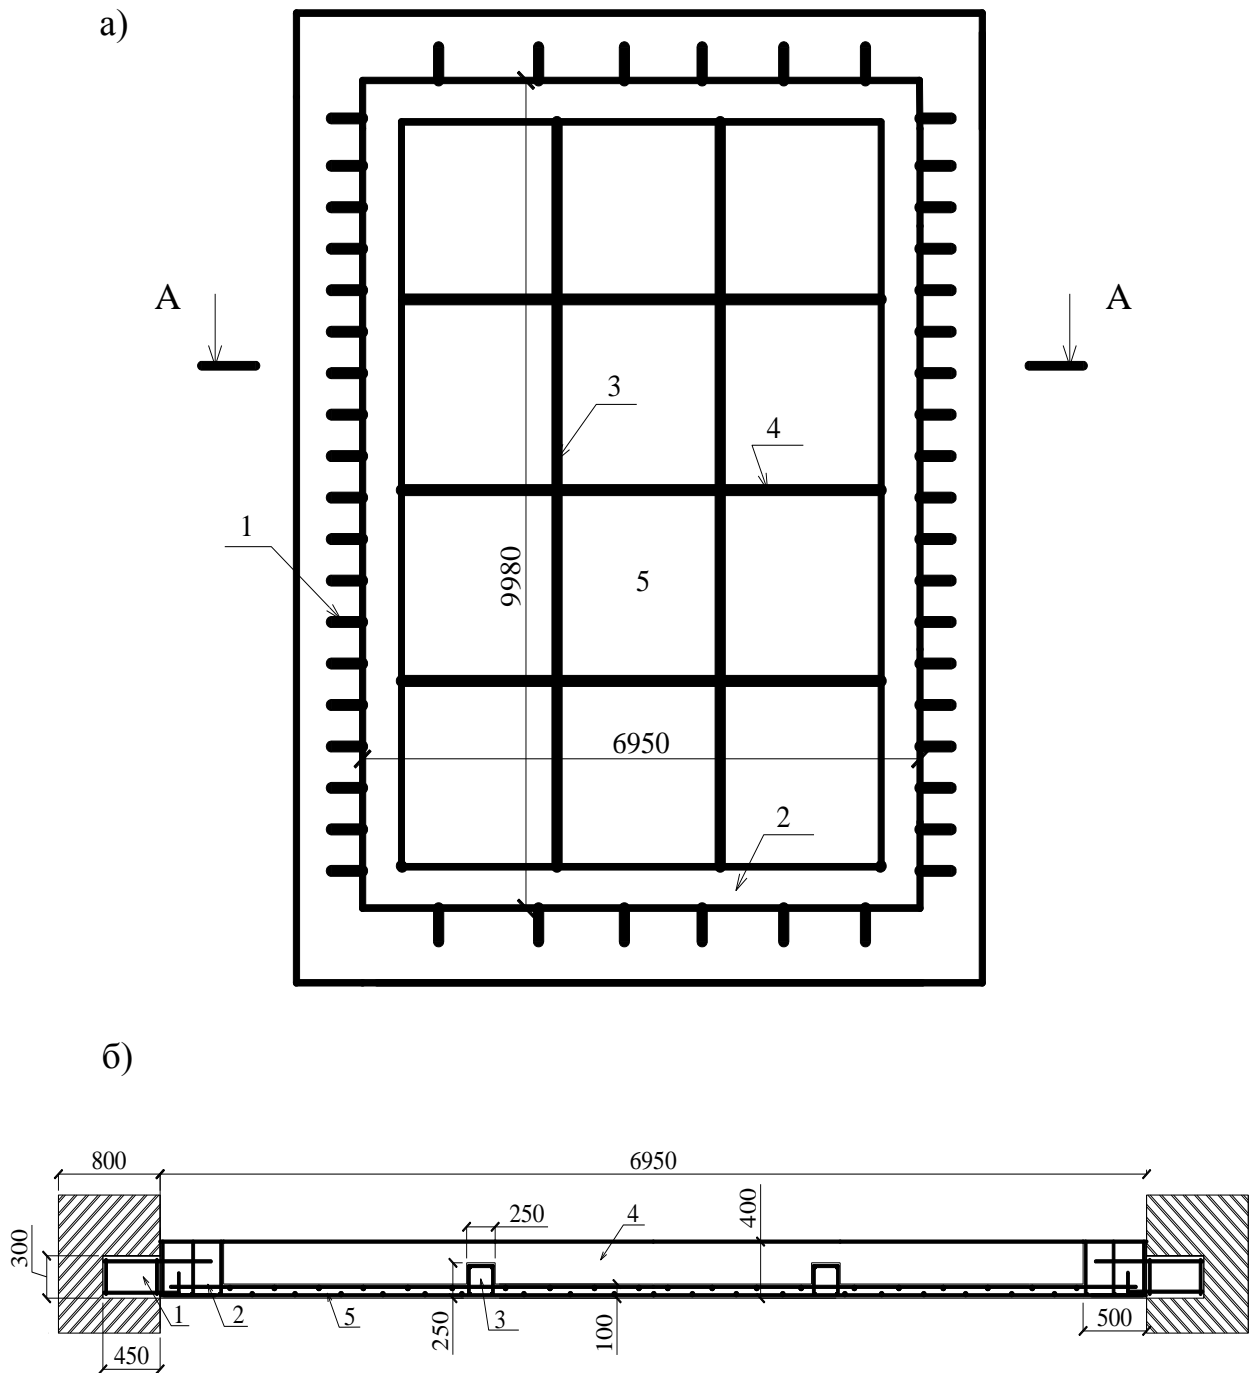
Приклад виконання різновиду реконструкції фундаментної системи шляхом підведення суцільної монолітної залізобетонної плити а) - вид в плані; б) - розріз А-А (масштаб збільшено у два рази): 1 - круглоциліндрична консольна балка; 2 - об'язувальна балка; 3 - другорядна балка; 4 - головна балка; 5 – плита.
